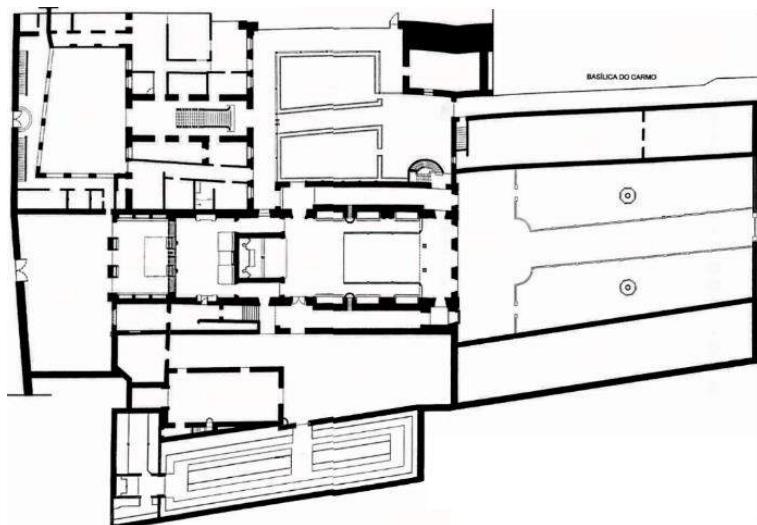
Planta Baixa do pavimento térreo da Igreja da Ordem Terceira do Carmo. Fonte: INBMI - IPHAN. 2015.
